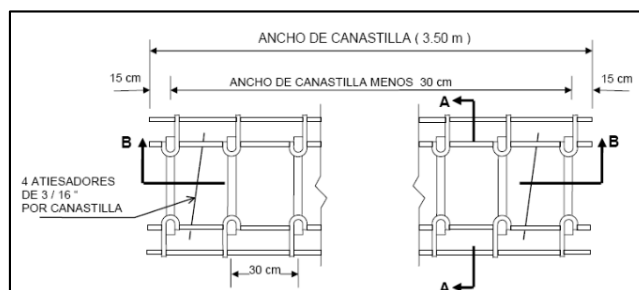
Vista en planta - Canastilla pasajuntas en juntas transversales de contracción
